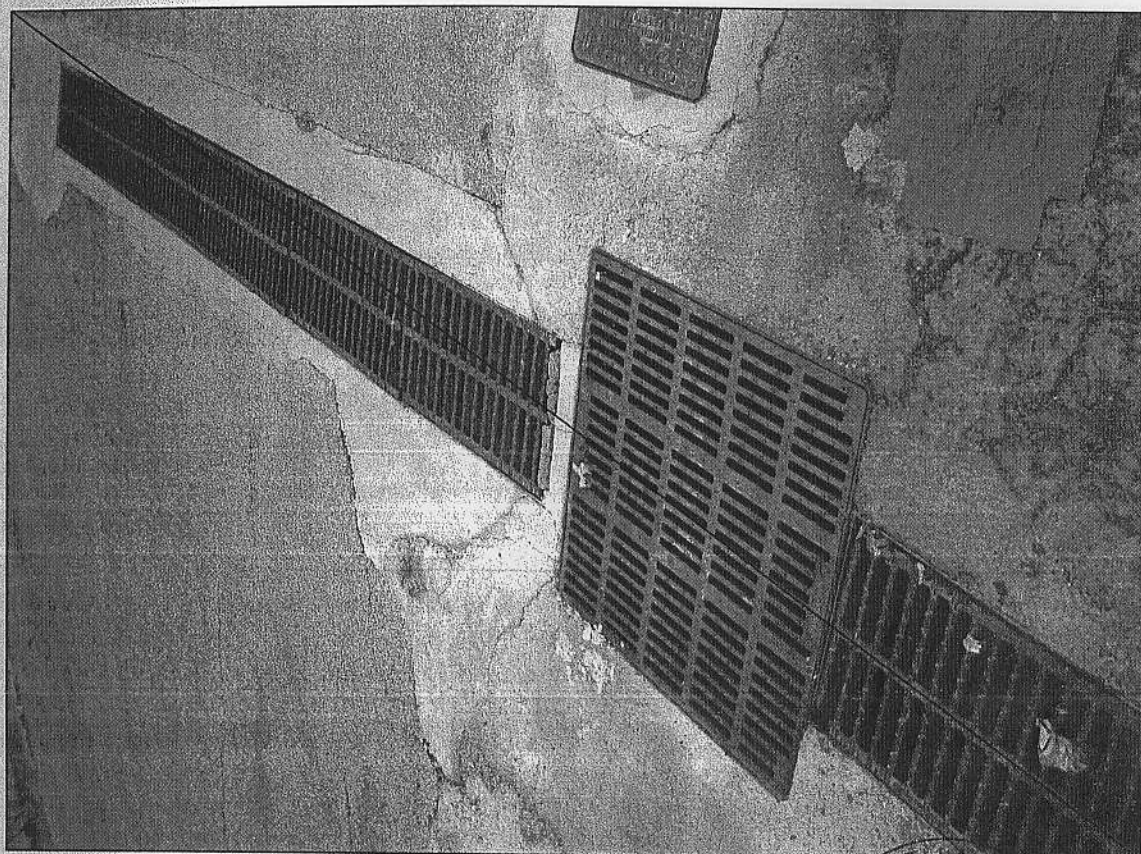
Caditoia della condotta fognaria acque bianche ubicata nei pressi dell'ingresso del complesso edilizio
